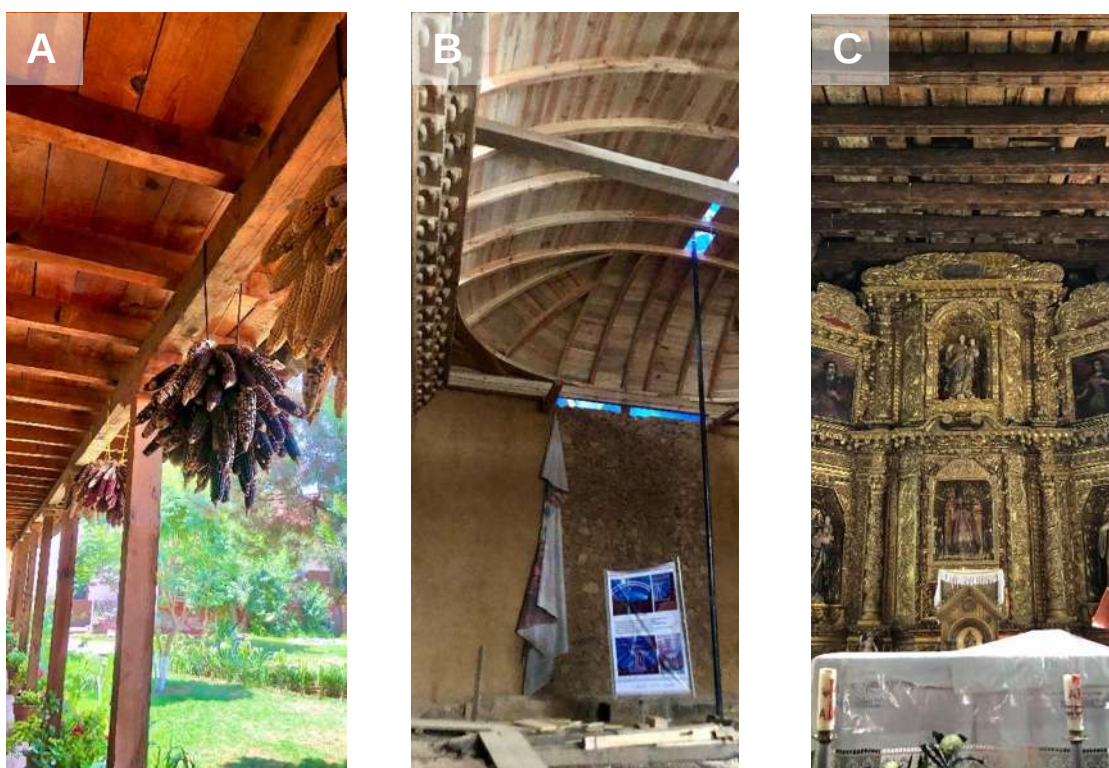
Estructuras de madera restauradas por daños antrópicos; (a) Secado de maíz sobre vigas de madera, Sevina, Michoacán; (b) Restauración de la cubierta de madera de la Parroquia de Santiago Apóstol, Nurio, Michoacán; (c) Degradación de cubierta y retablo por falta de mantenimiento en la capilla de San Nicolás Obispo, Michoacán.
